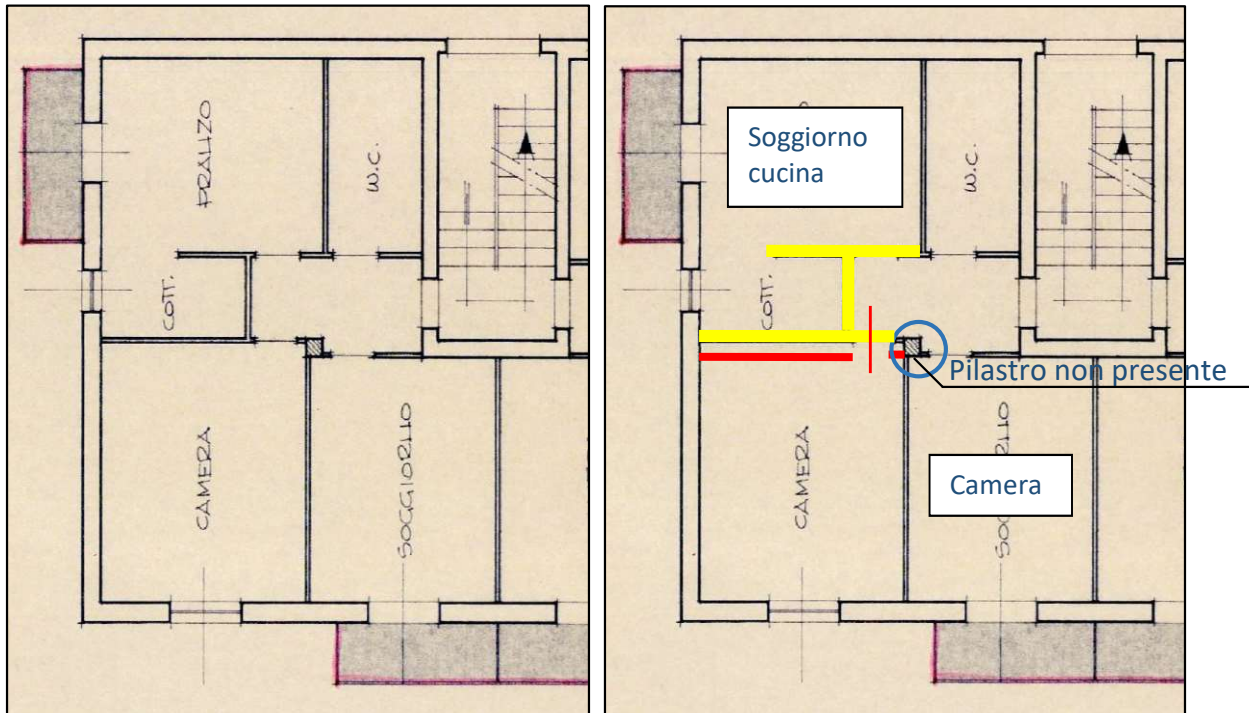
Planimetria allegata a C.E. dell' 11.09.1990
